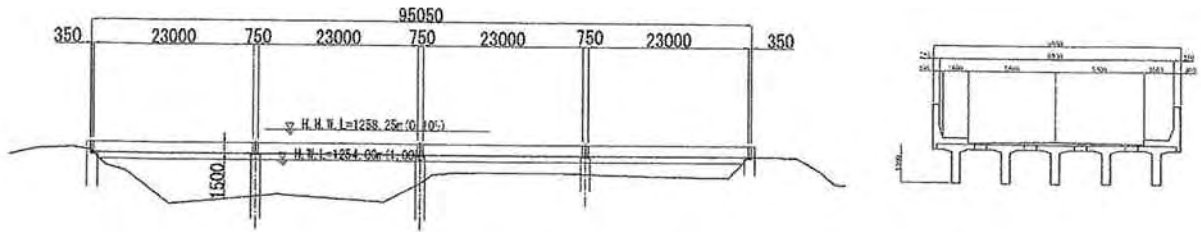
Plan du Pont à poutres en T simple avec système de précontrainte par tension après bétonnage (post-tension, longueur de travée : 23,0 m)
